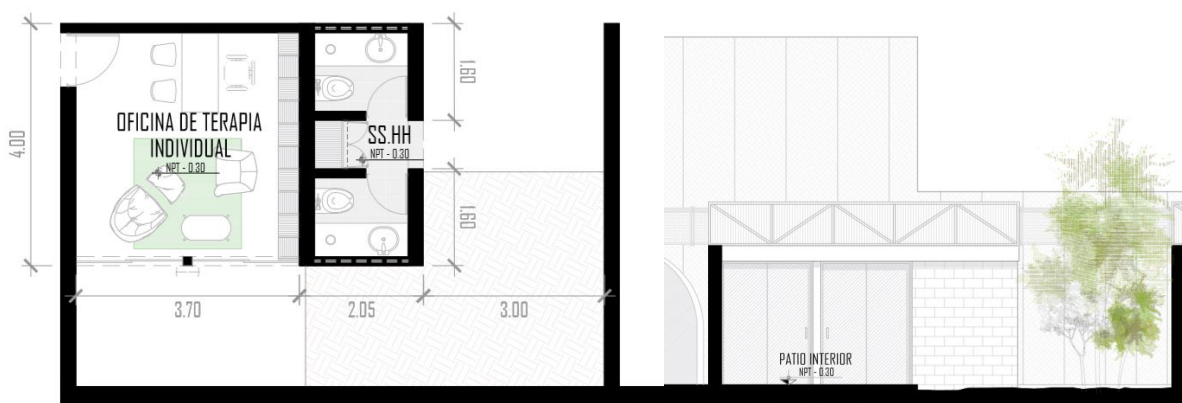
Vista en planta y elevación de la oficina de terapia individual.
